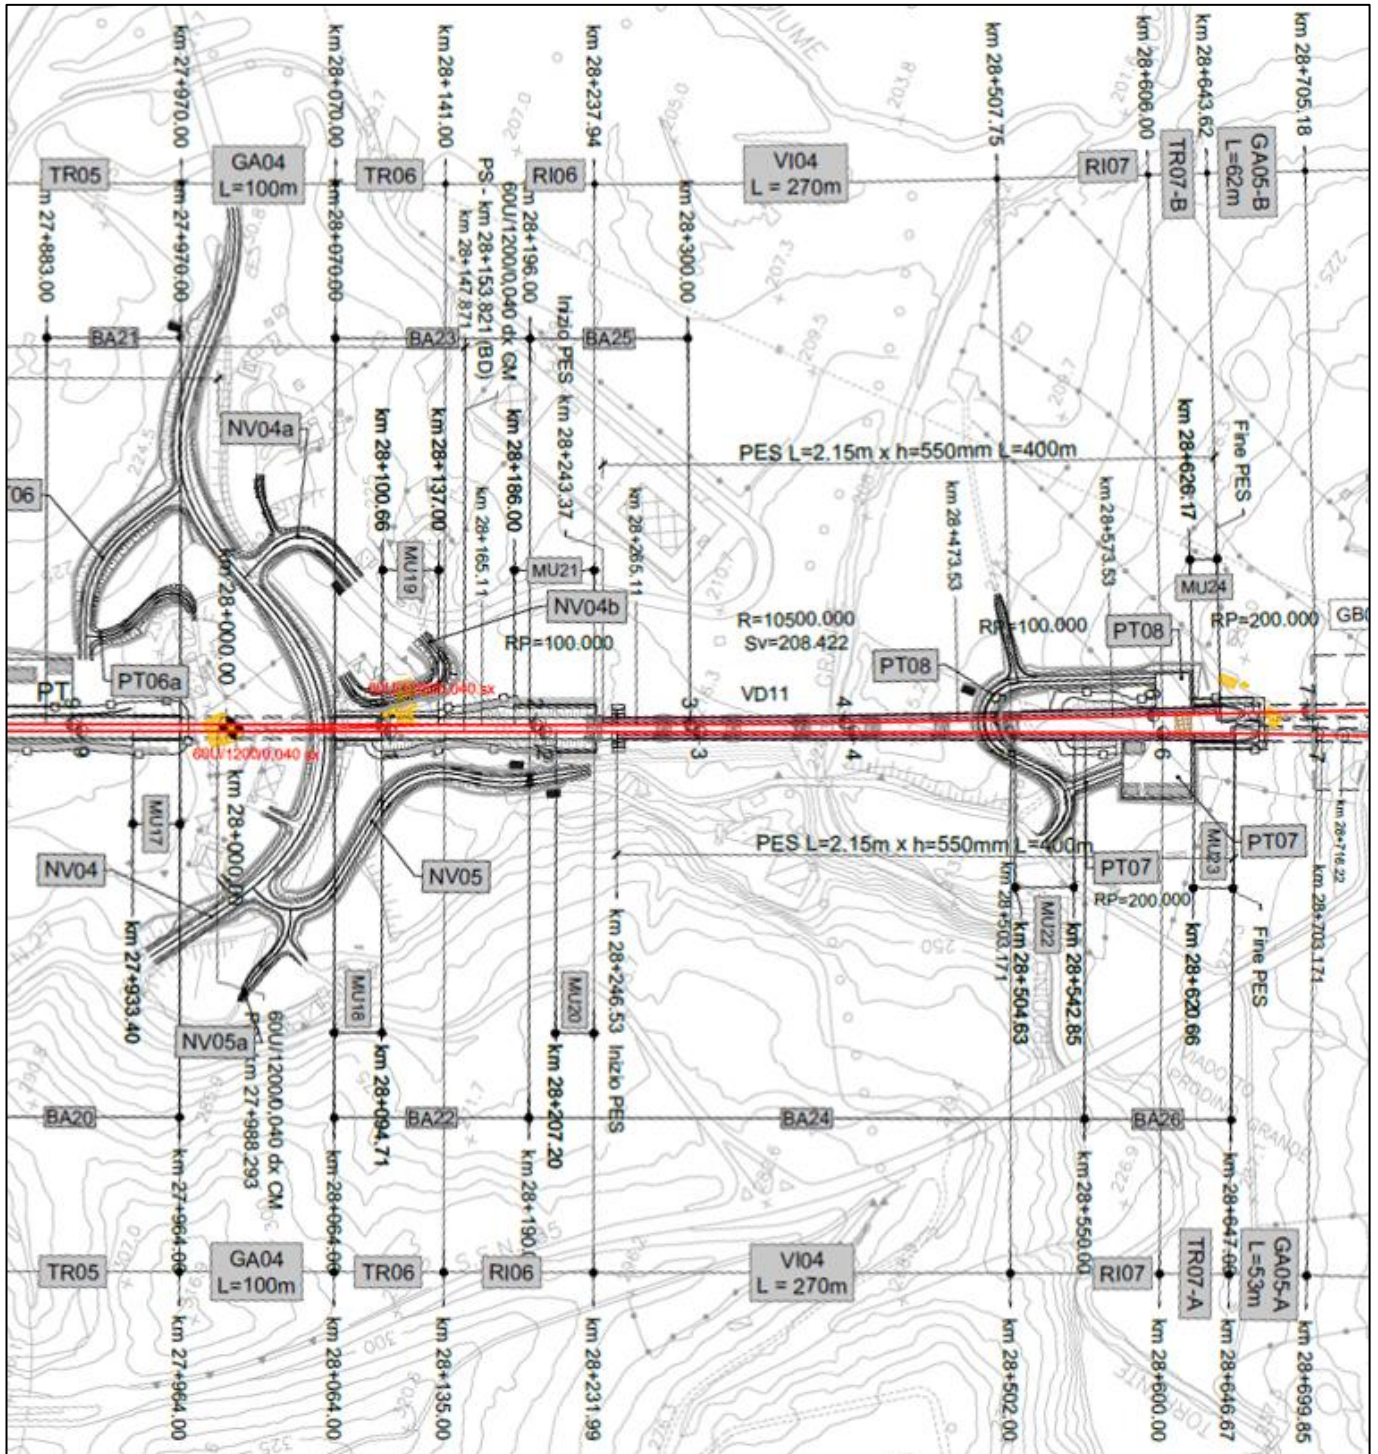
Planimetria di progetto da km 27+964 al km 28+646 BP
